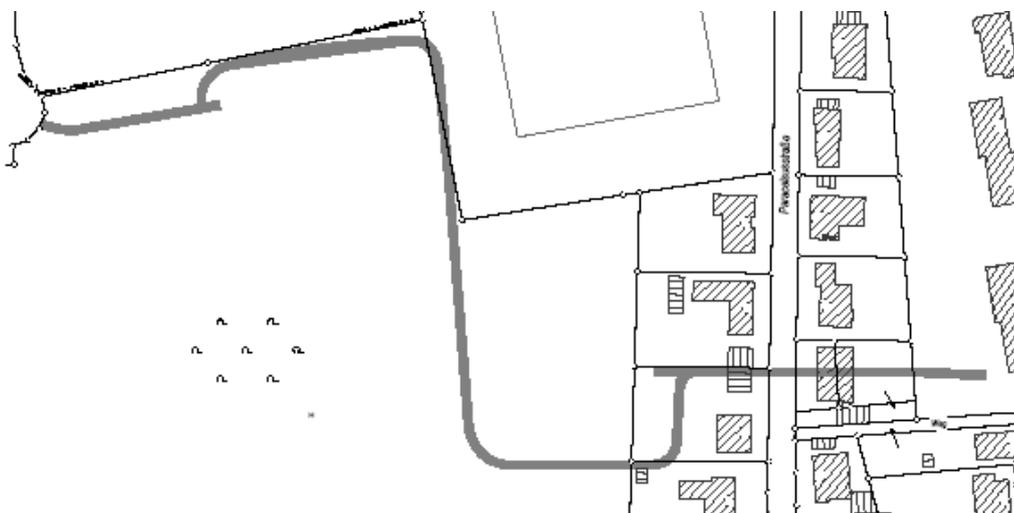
Lageplan Luftschutzstollen ZIESBERG
